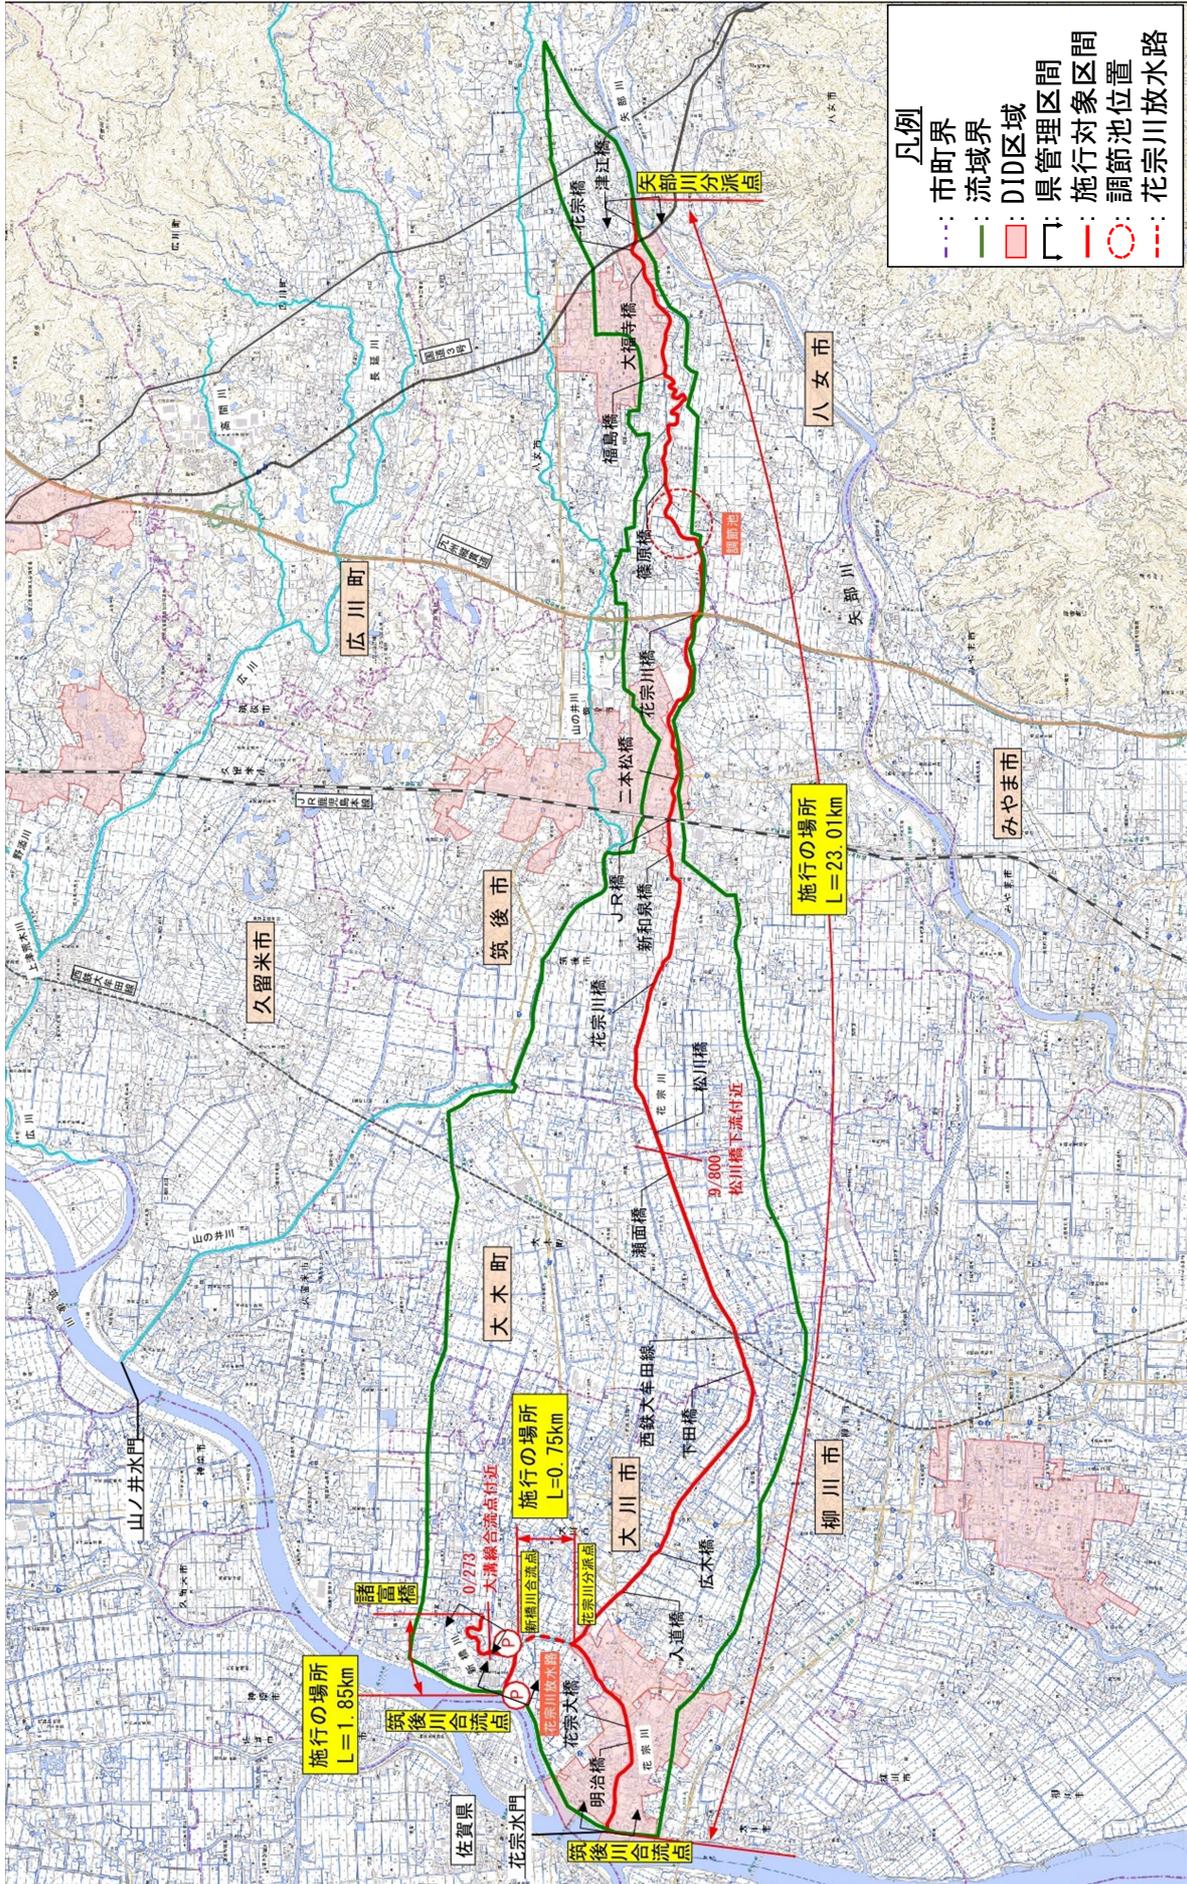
花宗川・新橋川整備計画平面図(施行の場所位置図・放水路・調節池位置図)
